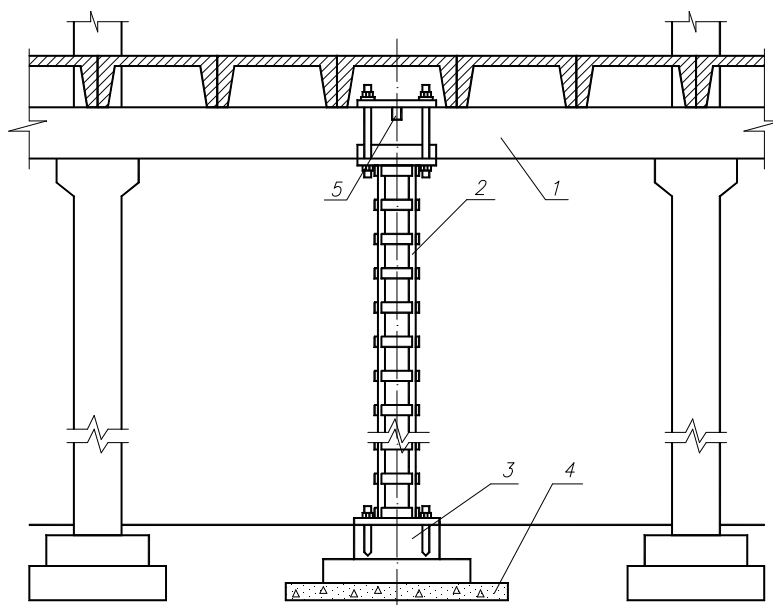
Усиление конструкции дополнительной жесткой опорой с самостоятельным фундаментом: 1 – усиливаемая конструкция; 2 – стойка дополнительной опоры; 3 – фундамент опоры; 4 – песчано-щебеночная подушка; 5 – надрез
